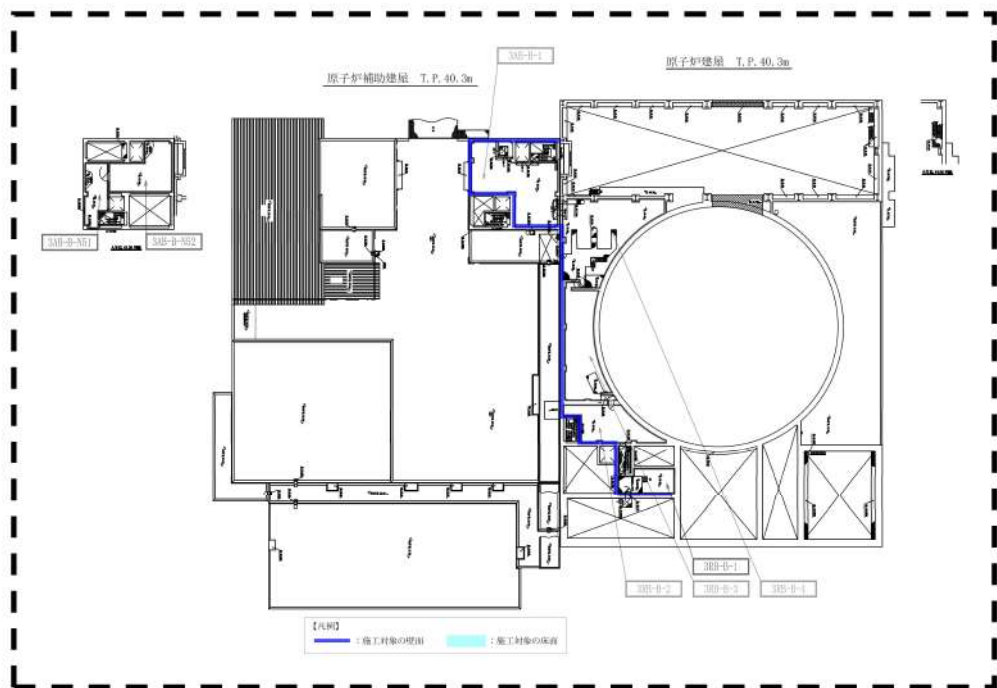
溢水防護対策施工対象の壁及び床の配置図 (1/11)
